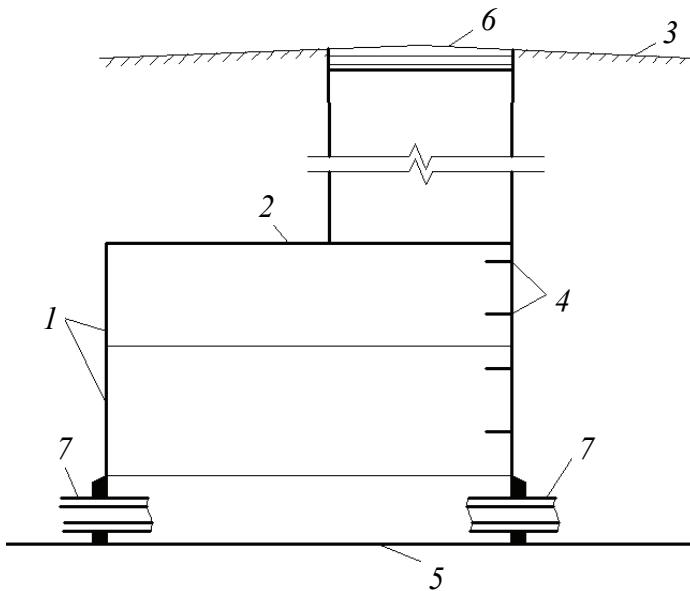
Схема устройства водопроводного колодца: 1 – кольца; 2 – плита перекрытия; 3 – каменная отмостка; 4 – ходовые скобы; 5 – плита днища; 6 – чугунный люк с крышкой; 7 – трубопроводы
